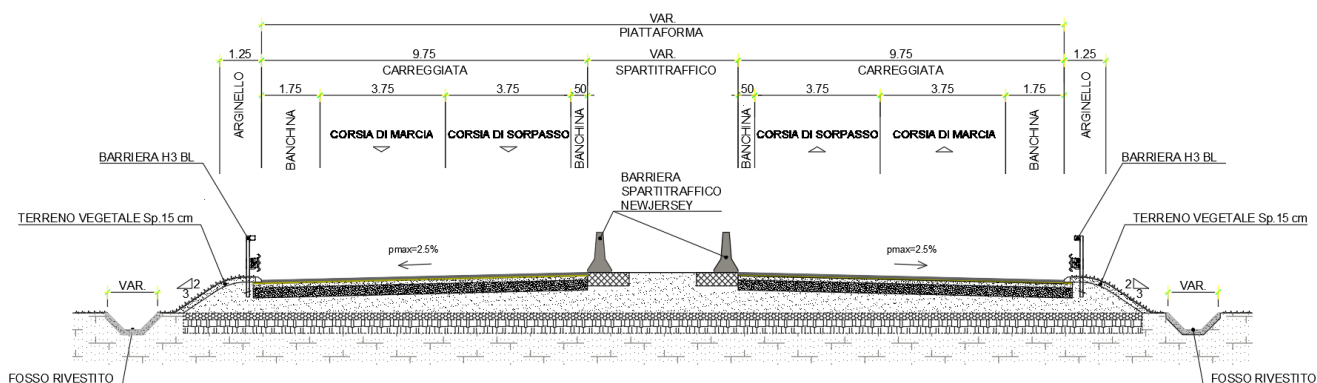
Sezione tipologica tratto stradale oggetto della progettazione
